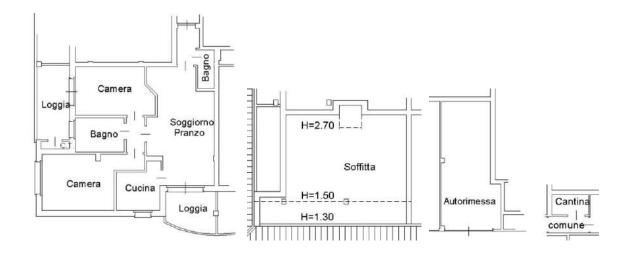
Estratto planimetria catastale appartamento cantina e autorimessa.
